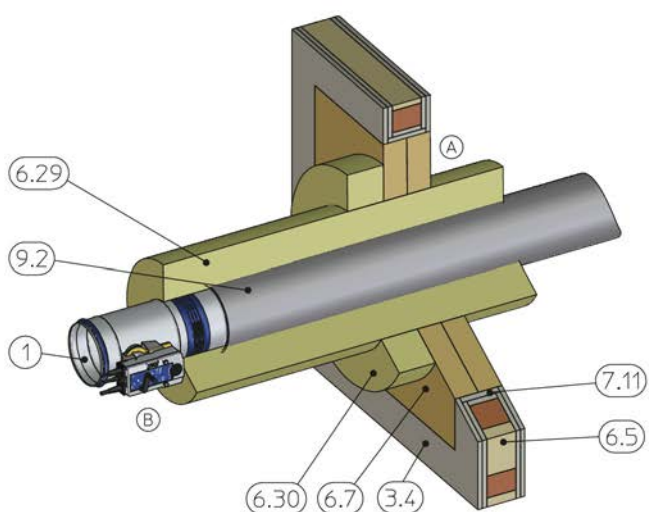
Монтаж без применения строительного раствора в легких перегородках с фахверковой конструкцией с монтажным комплектом TQ / TQ2
